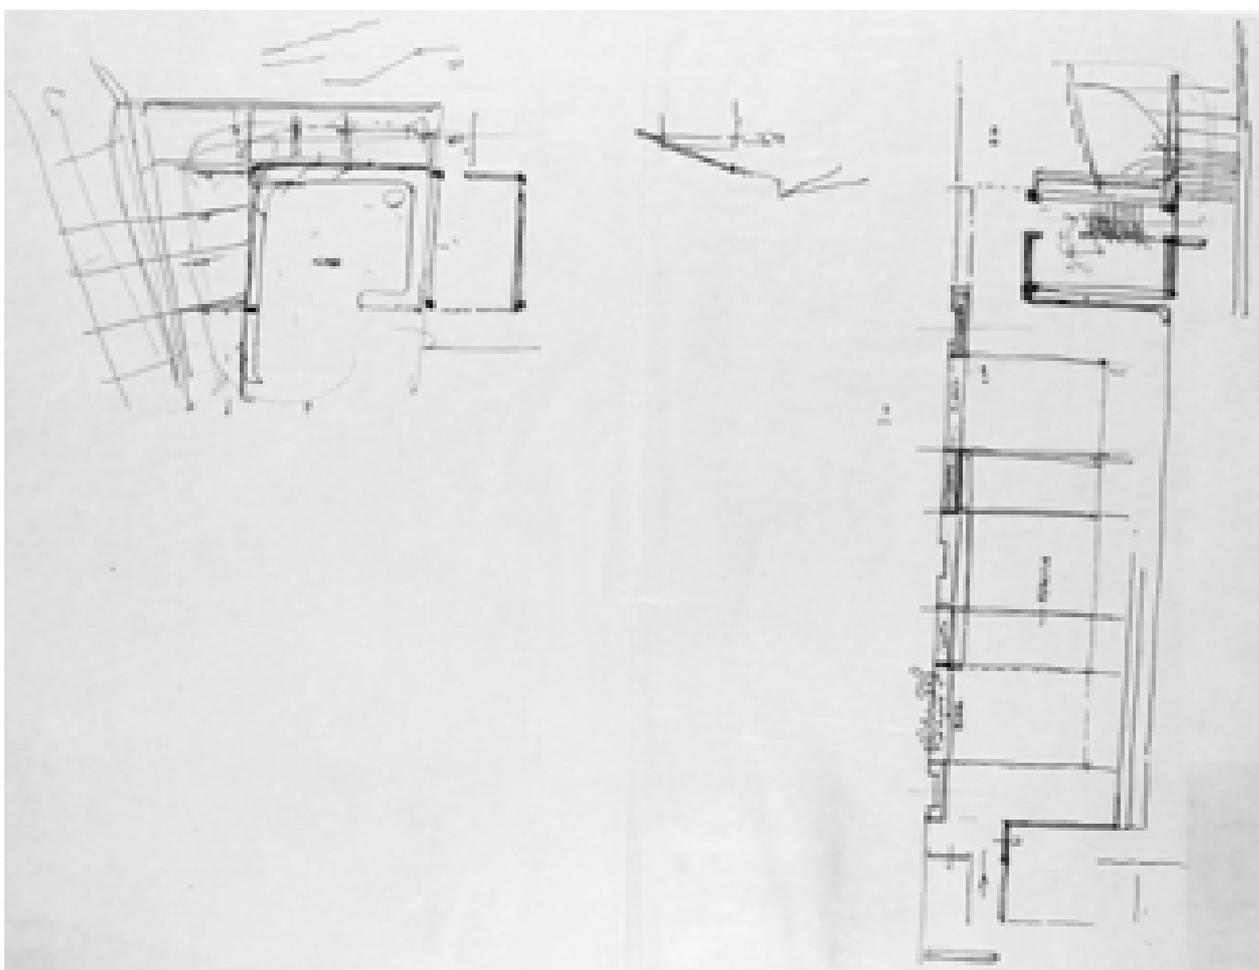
Studio planimetria – s.d. (AABS-94.106)
